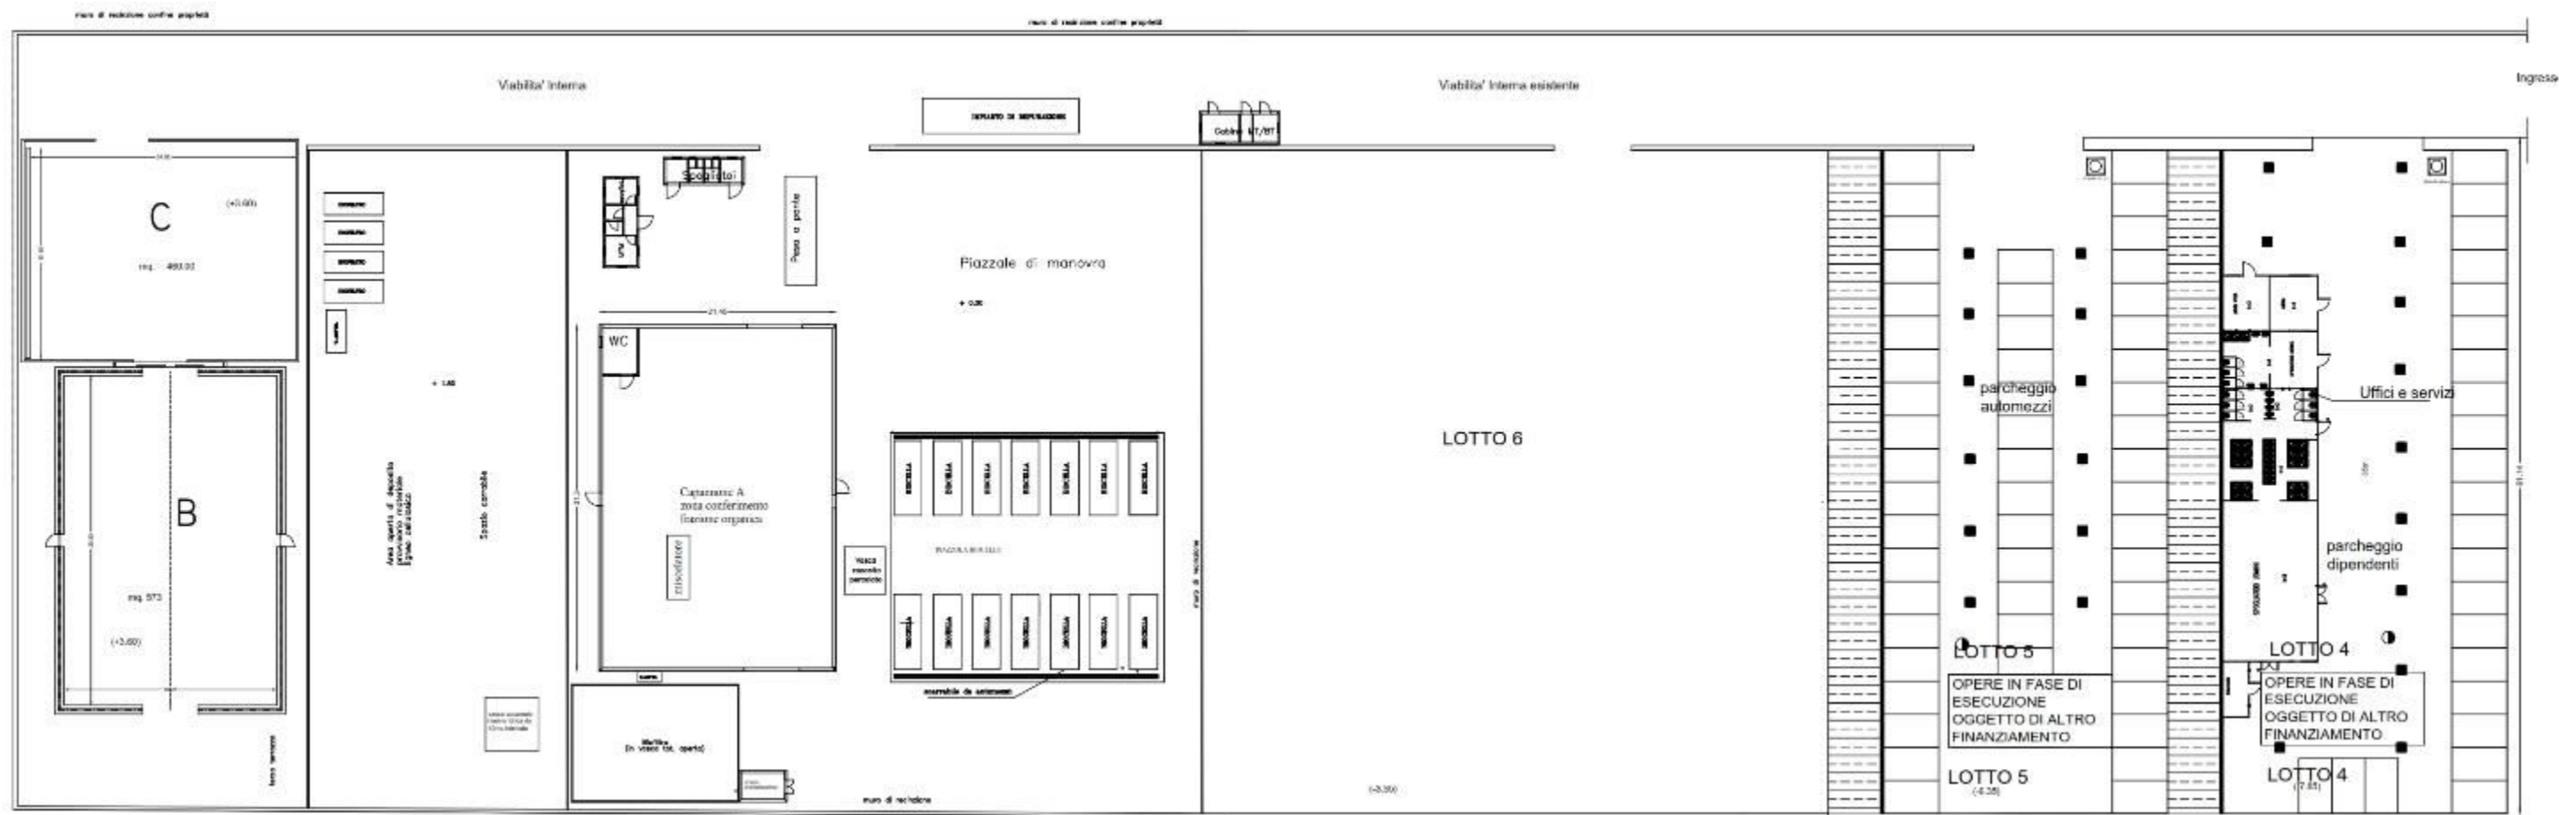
Planimetria generale dell'Impianto di Compostaggio - Assetto Attuale
